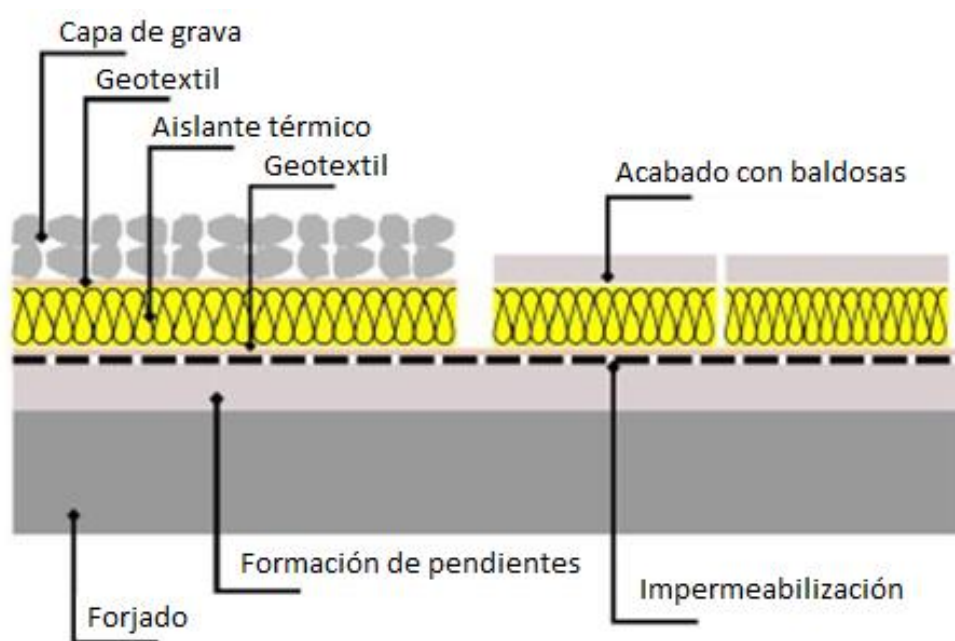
Aislamiento de azotea. Cubierta invertida.
